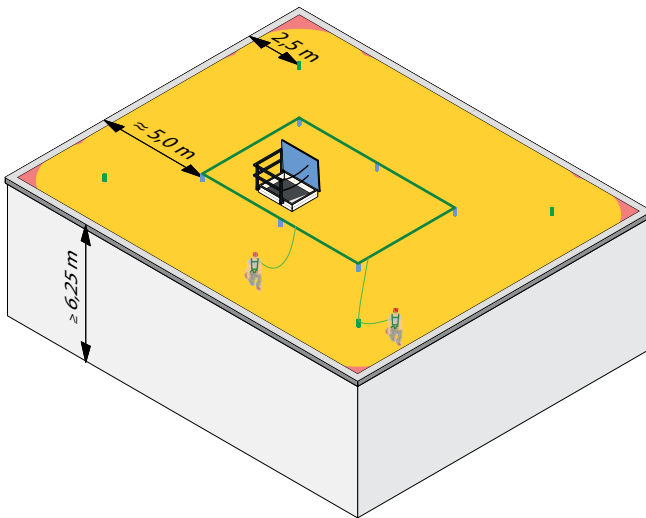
Ausstattungsklasse 2: Ein Sturzauffangsystem kombiniert mit EAP in den Ecken
